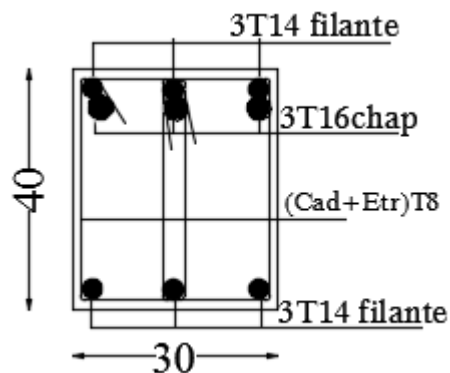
Ferrailage sur appuis d'une poutre principale.
